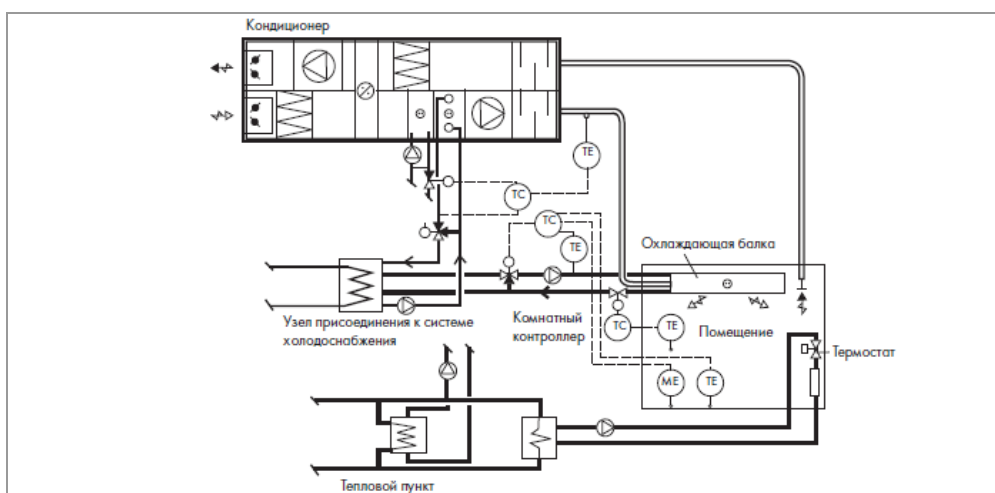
Схема системы кондиционирования воздуха с механической приточной и вытяжной вентиляцией и охлаждающими балками (здание в Финляндии)
